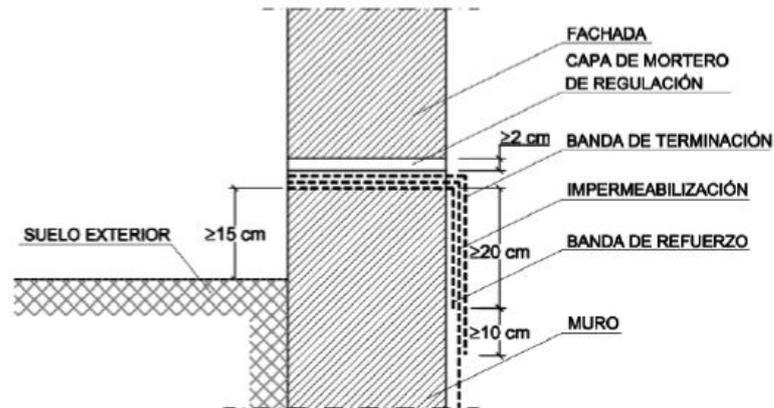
Ejemplo de encuentro muro-fachada (Fuente: [14])
